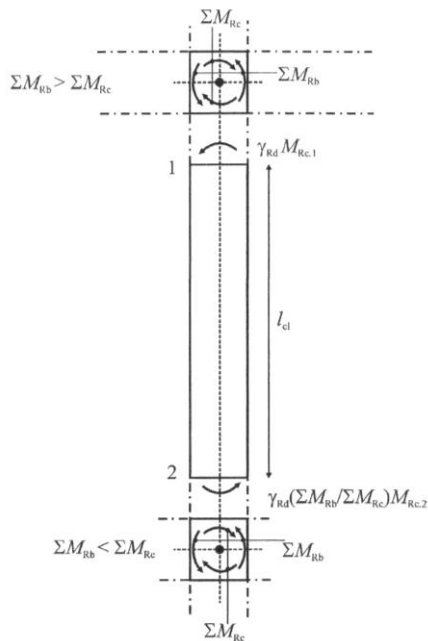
Проектні значення перерізуючих сил в колонах при навантаженні
